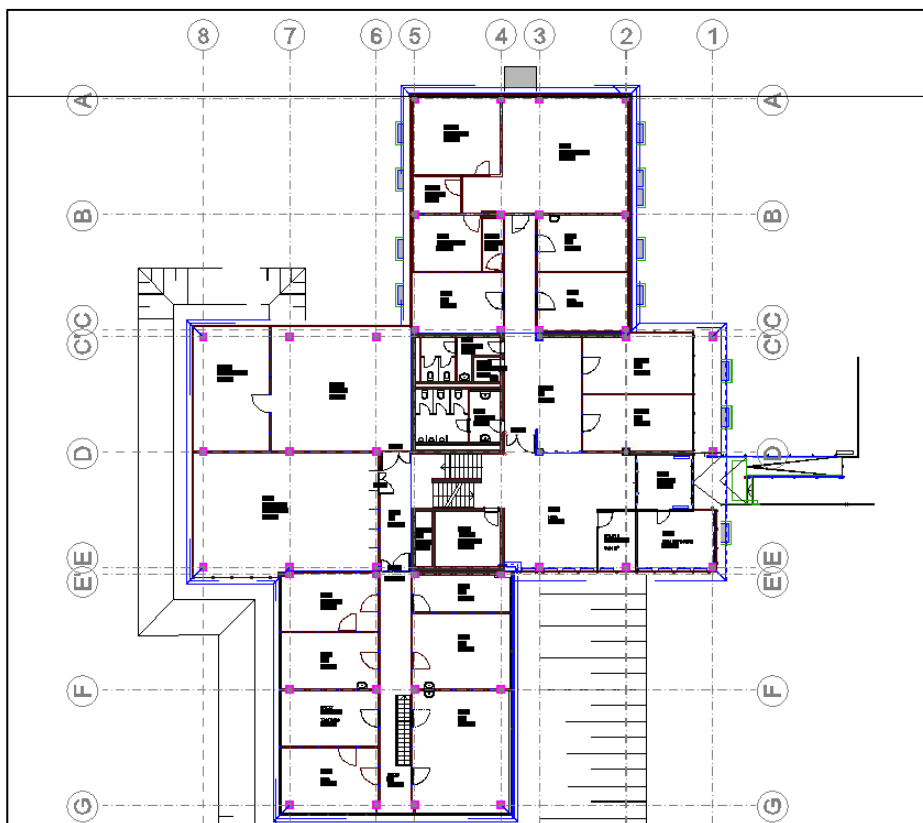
Grundriss Bauteil B (Betriebsdienstgebäude), EG
